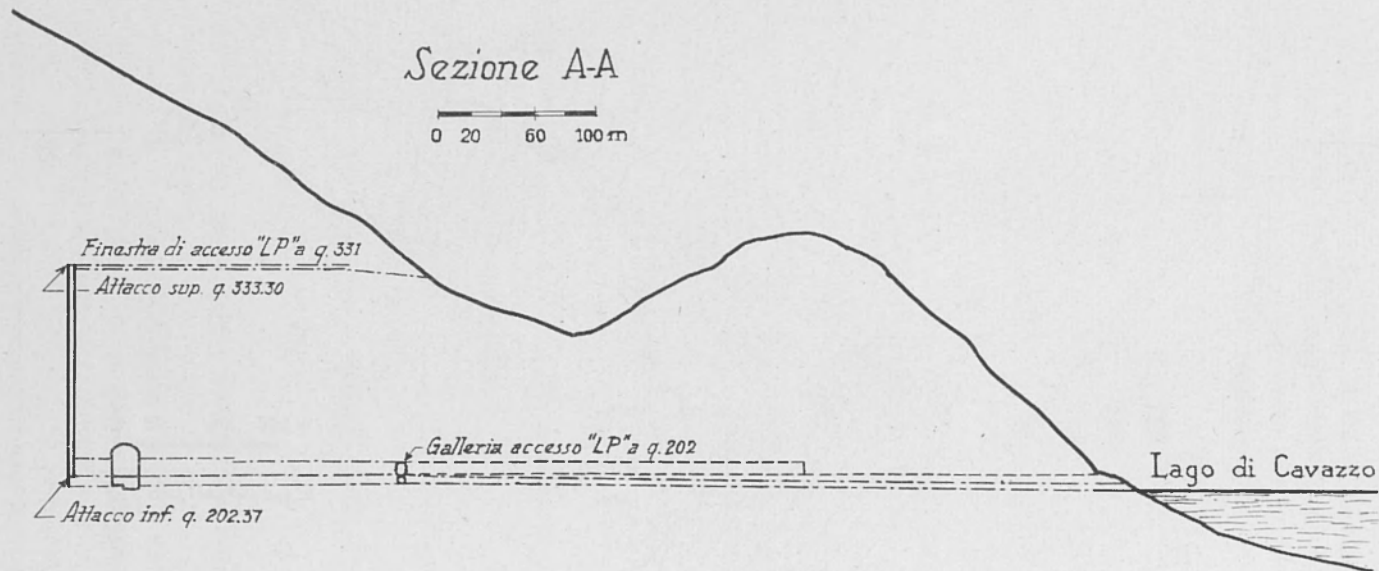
Sezione verticale A-A, come da planimetria (v. Fig. 2).
